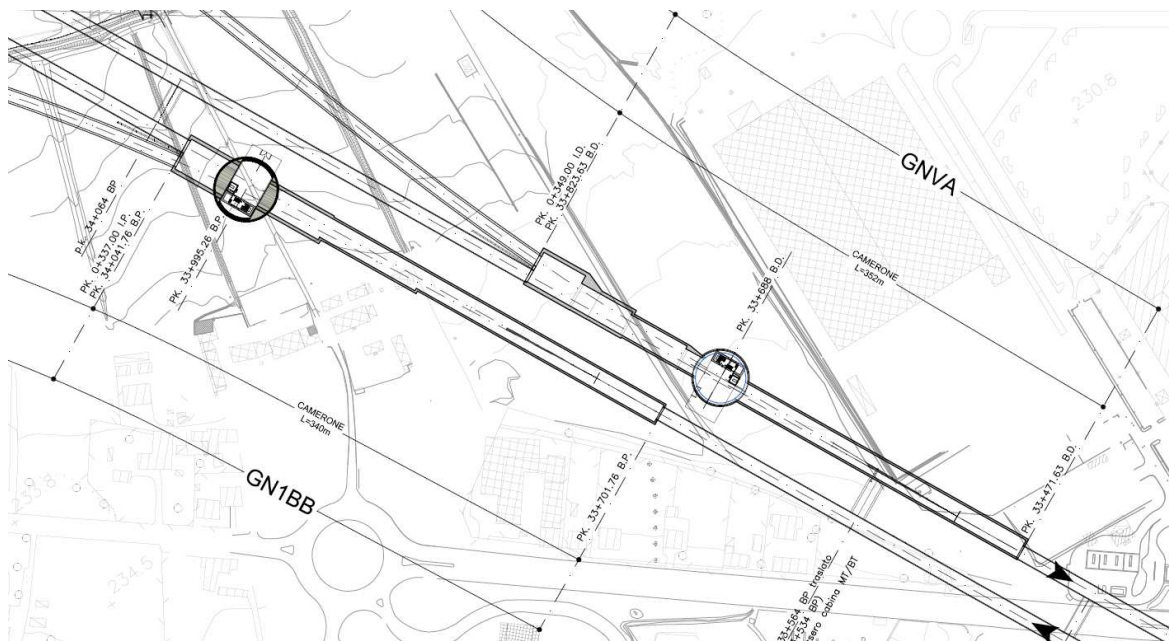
Stralcio planimetrico della zona dei camerone e pozzi di entrambi i binari dell'Interconnessione
